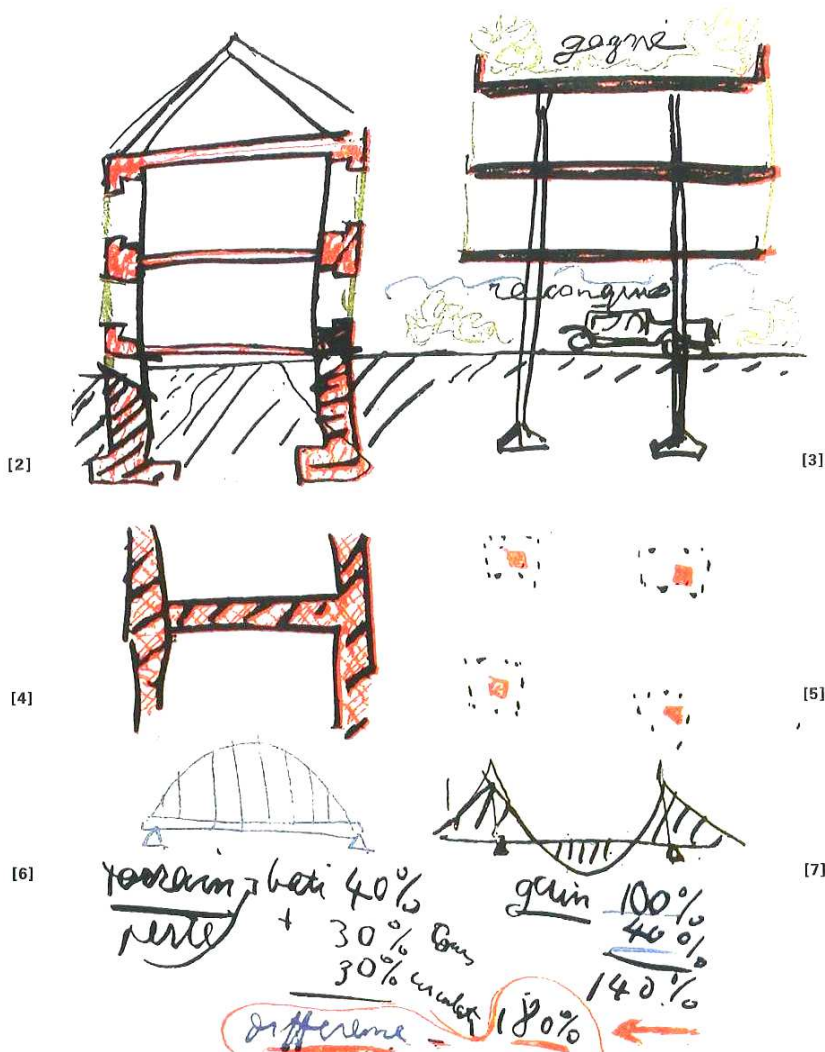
Croquis comparativos entre casas de “pedra” e concreto ou aço
